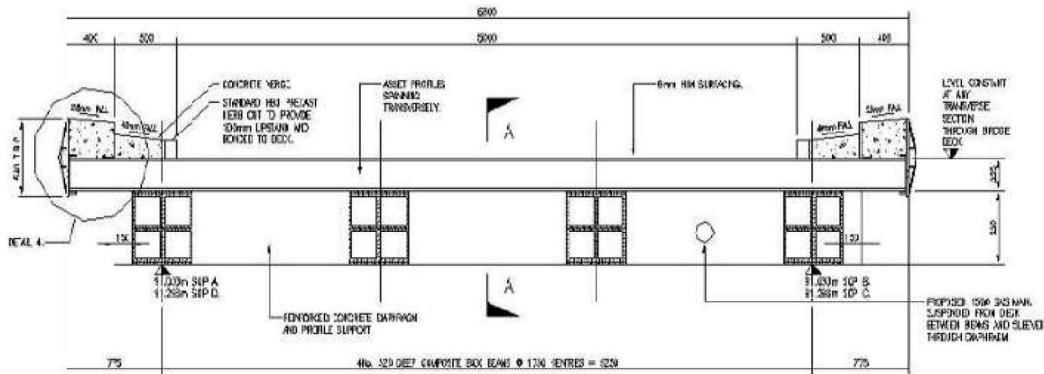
Conexión viga-tablero y viga-pilar.
